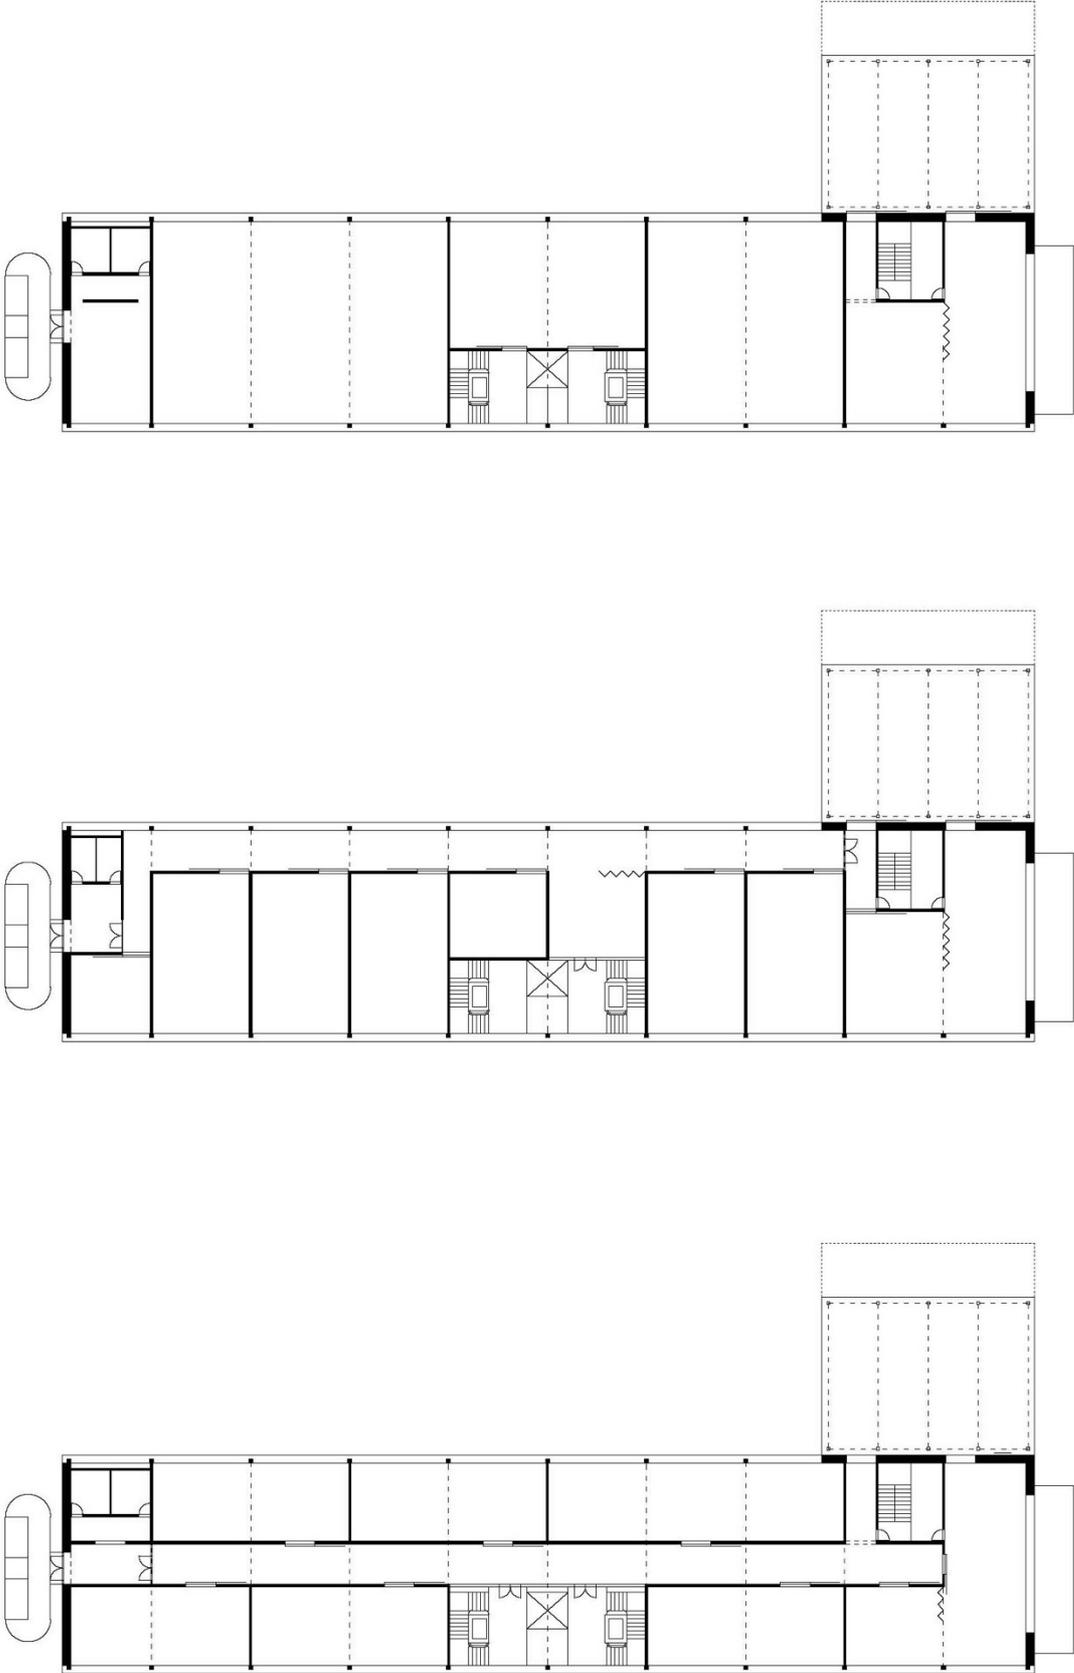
Dachaufstockung - Varianten zur Grundrissorganisation. Autoren: PLURAL
